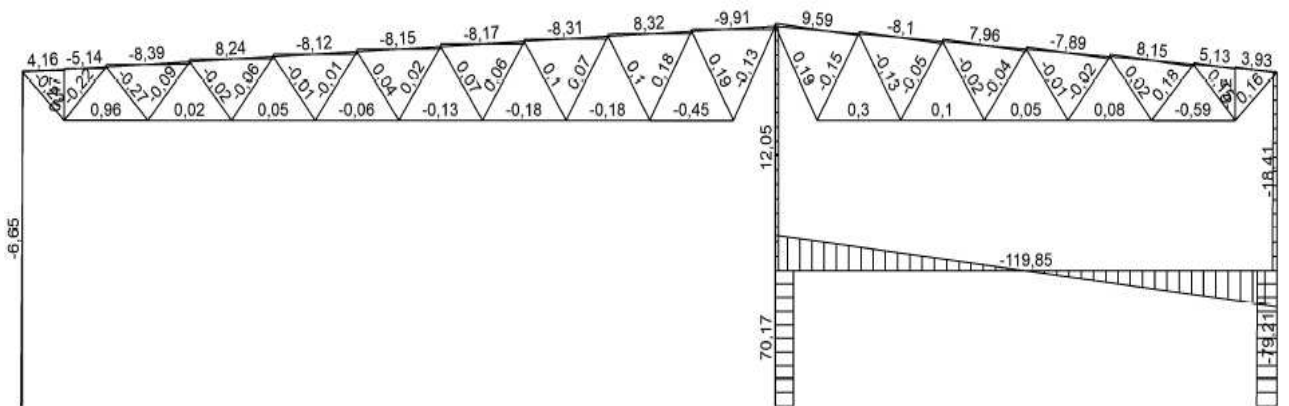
Эпюры поперечных сил Q (кН) от расчетного сочетания нагрузок
